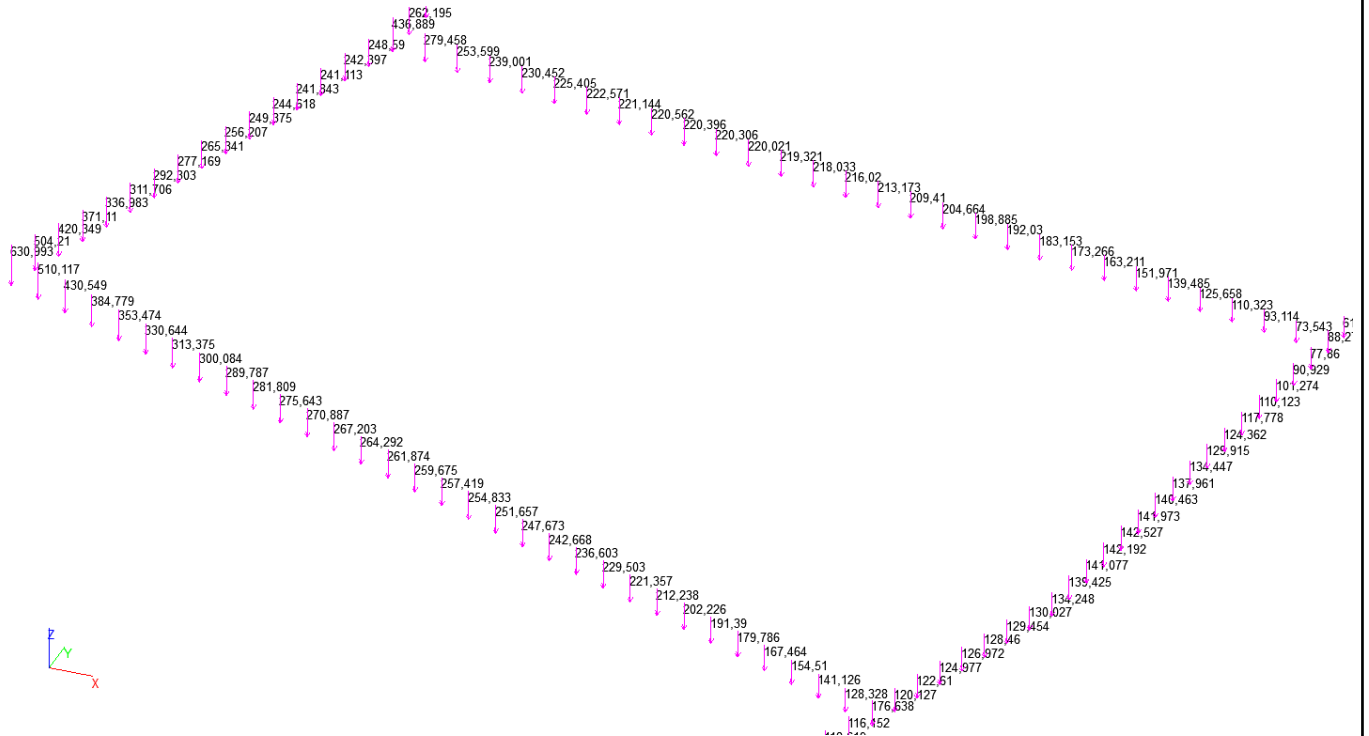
Нагрузки в узлах основания колонн, кН
